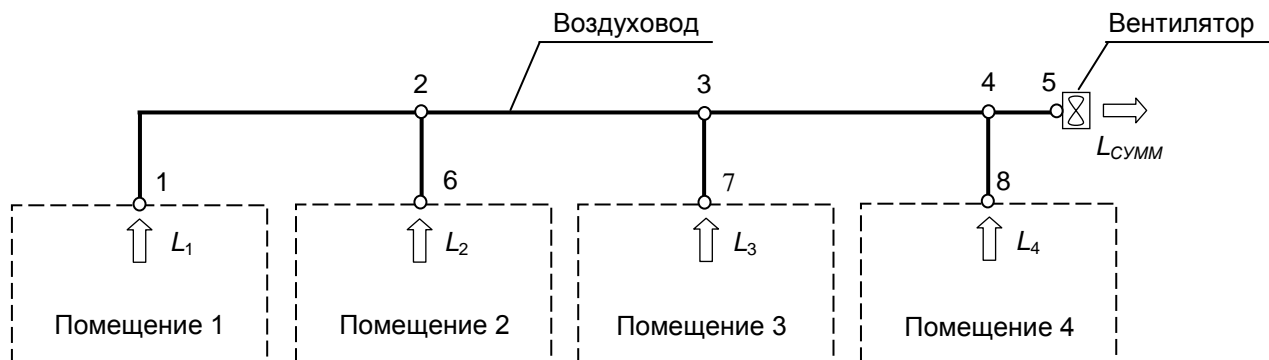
Расчетная схема системы вентиляции четырех помещений
